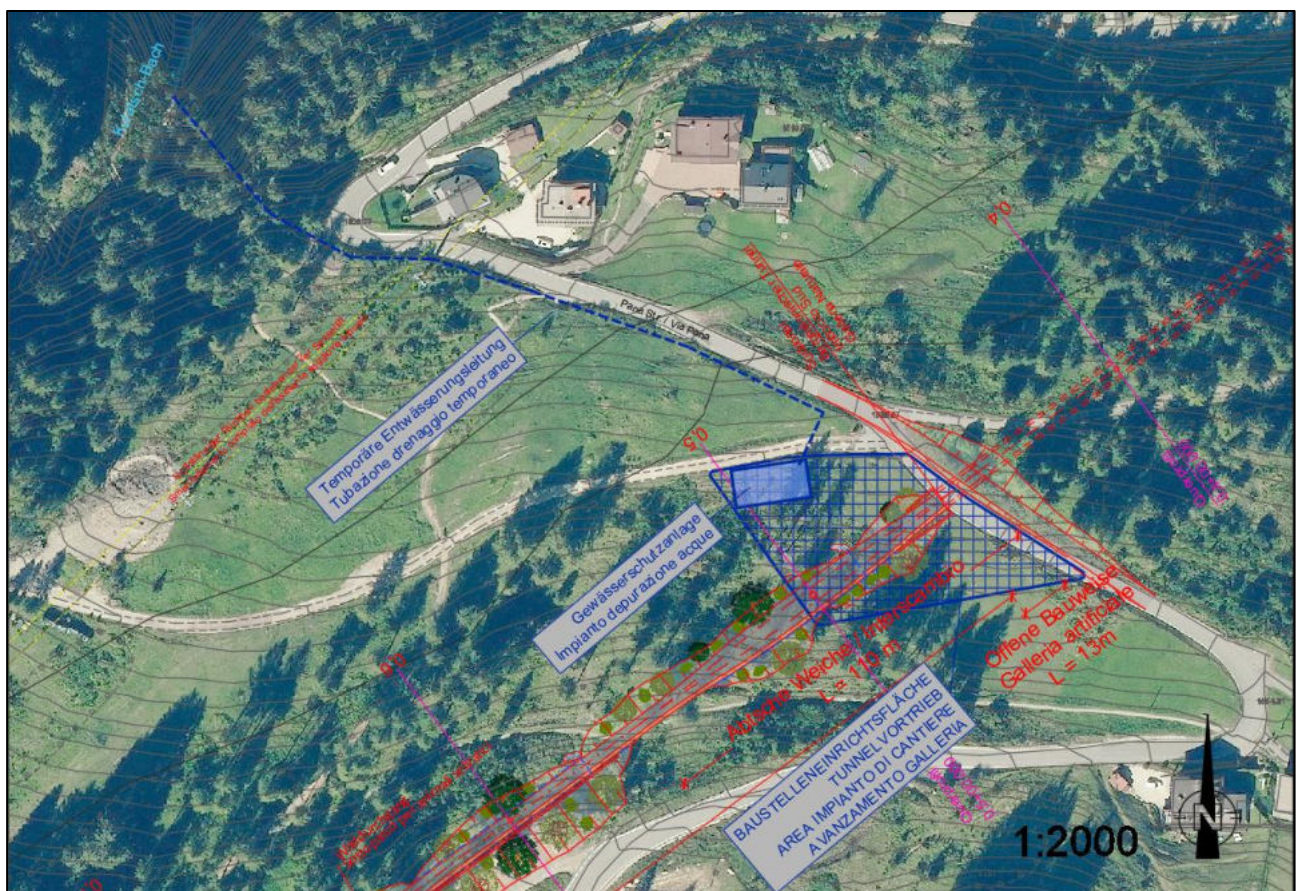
Lageplan mit Baustelleneinrichtungsfläche und Aufbereitungsanlage sowie Ableitung
